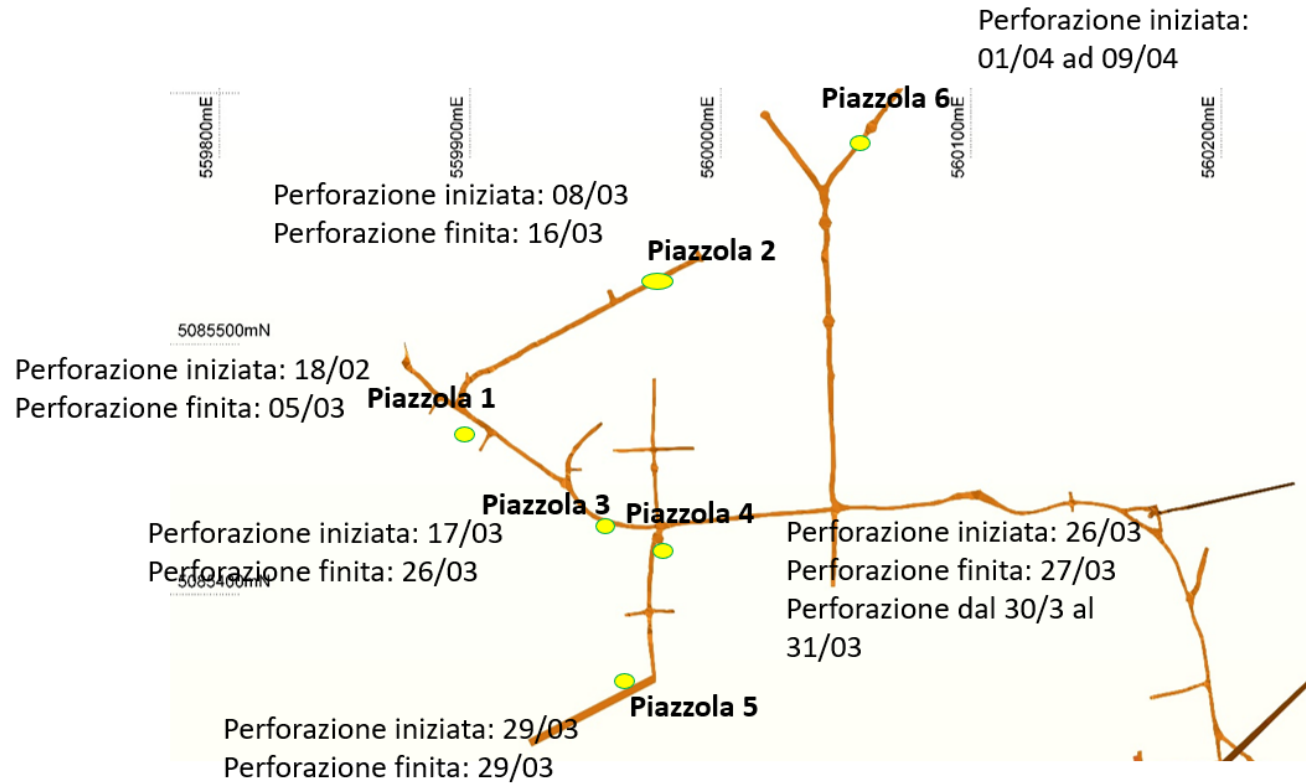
Planimetria delle aree di sondaggio a livello Ponente nel periodo 09/03 a 09/04 2021.
